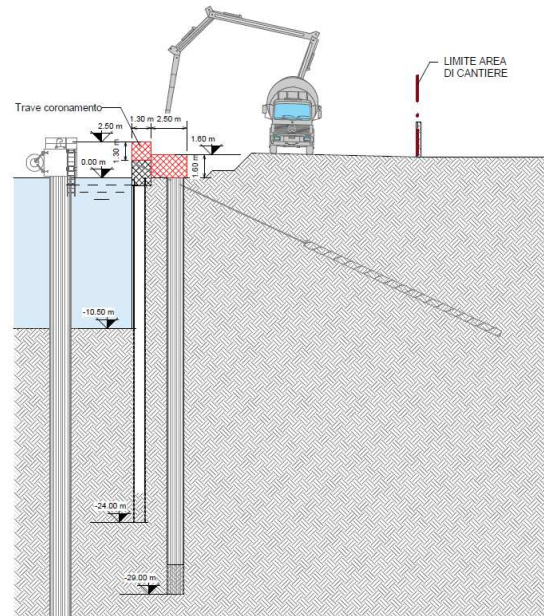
Sezione con indicazione della trave di coronamento di progetto.
